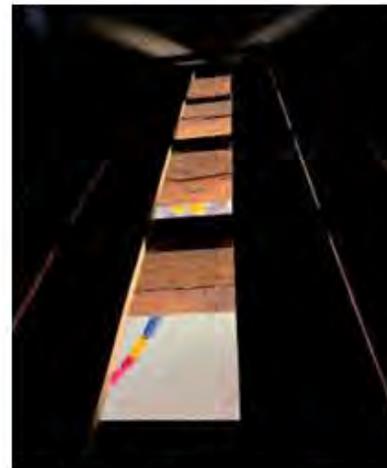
Vista sobre plafón de madera hacia el interior del templo, Fuente: archivo propio, 2024
